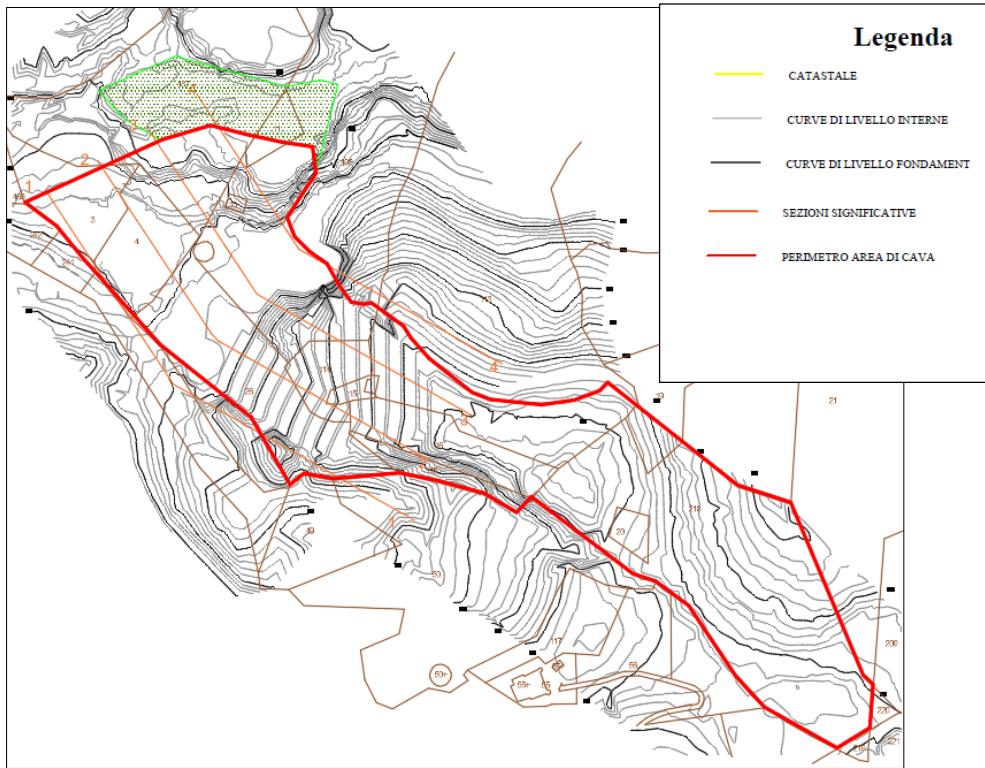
PLANIMETRIA 1° STADIO DI COLTIVAZIONE
